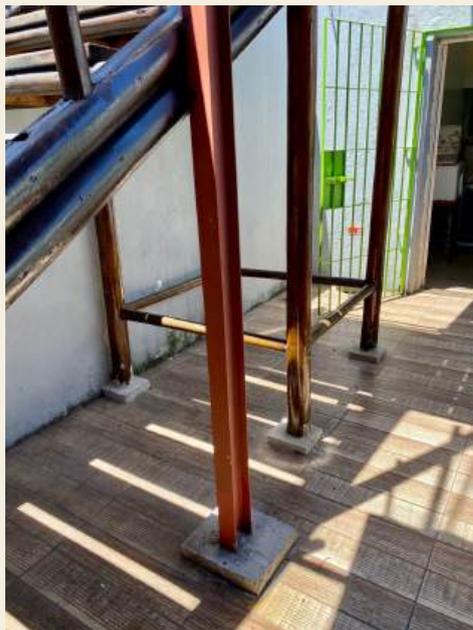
Detalhe estrutura do Telhado ECO. Escada de acesso.
